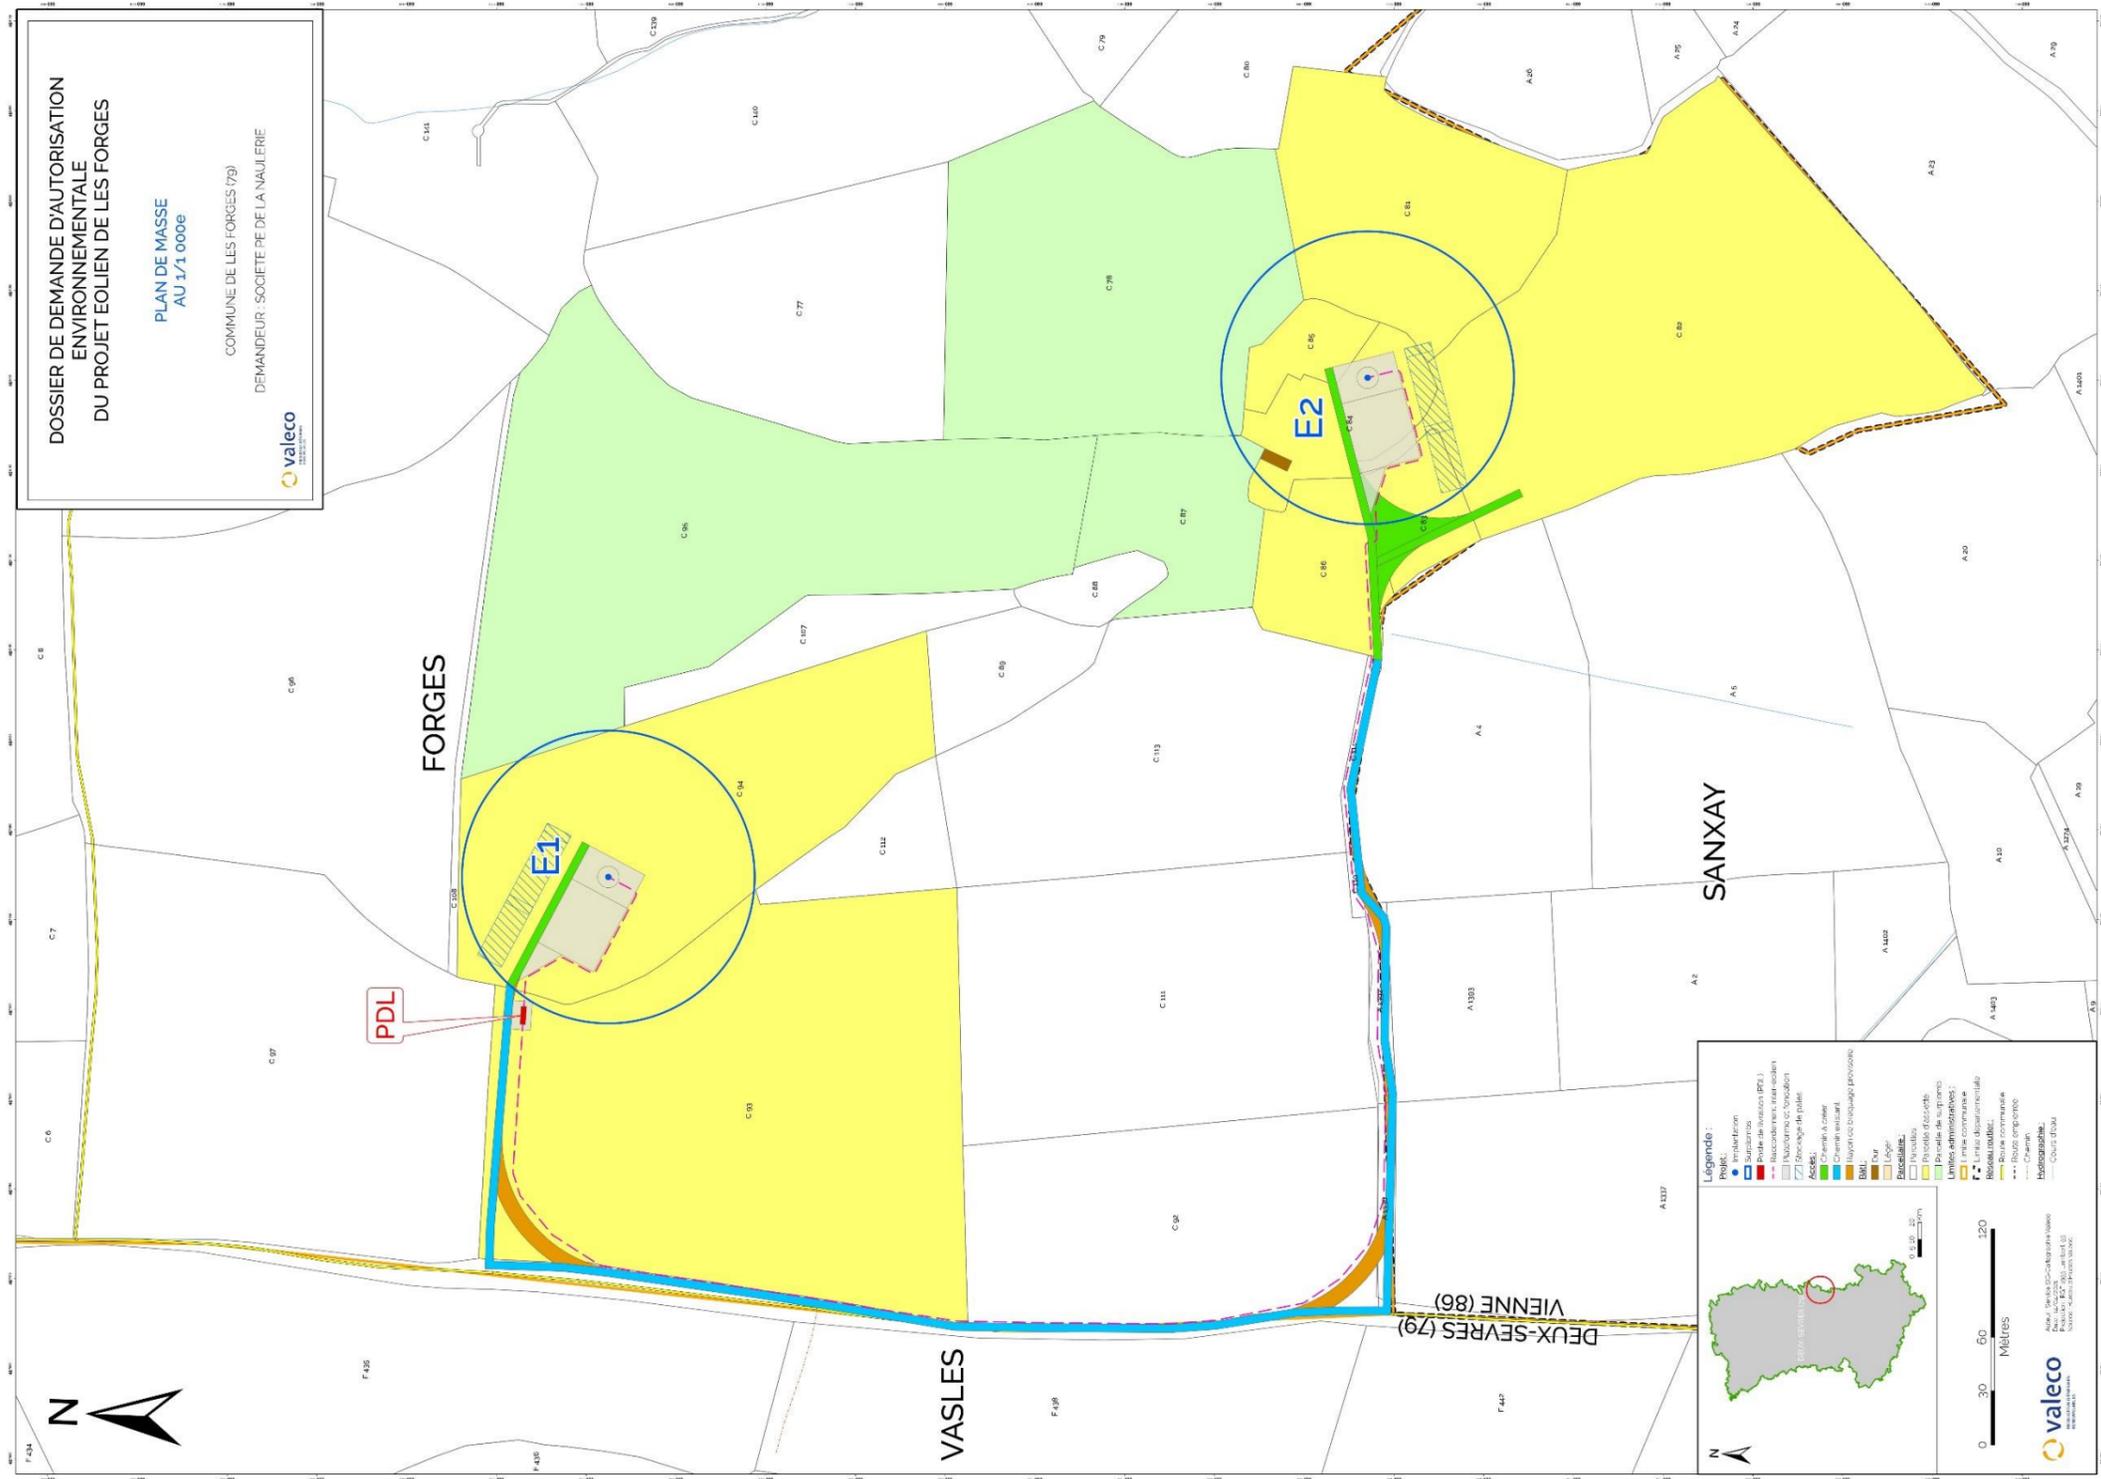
Plan de masse de E1, E2 et PDL (disponible en pièce 10)
